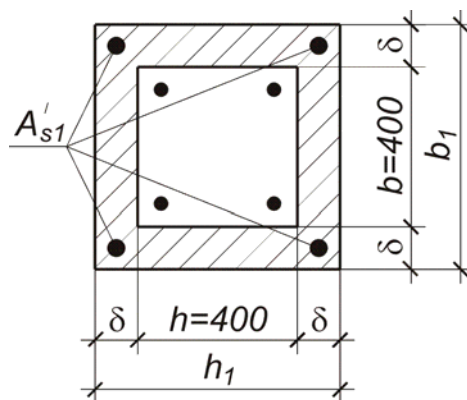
Расчетное сечение колонны, усиленной железобетонной обоймой
